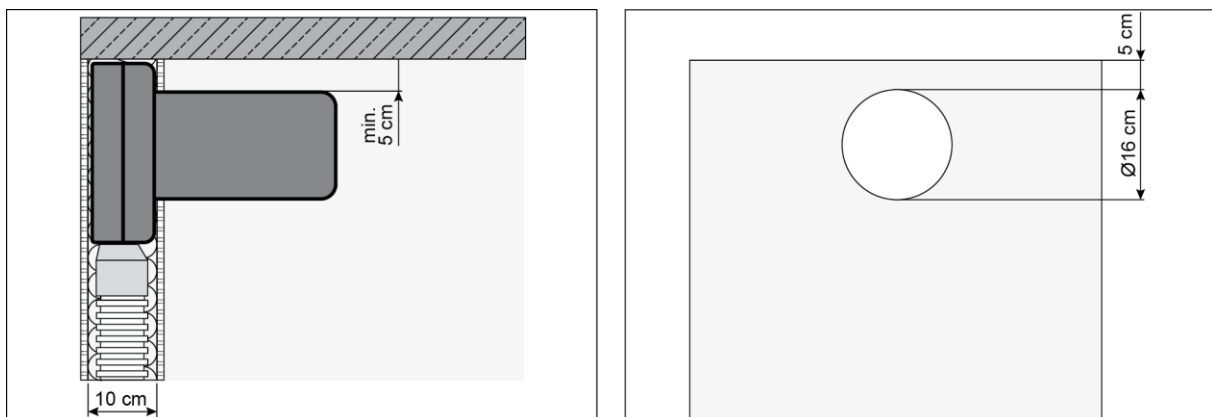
Montage in Trockenbauwänden, Seiten- und Frontansicht
